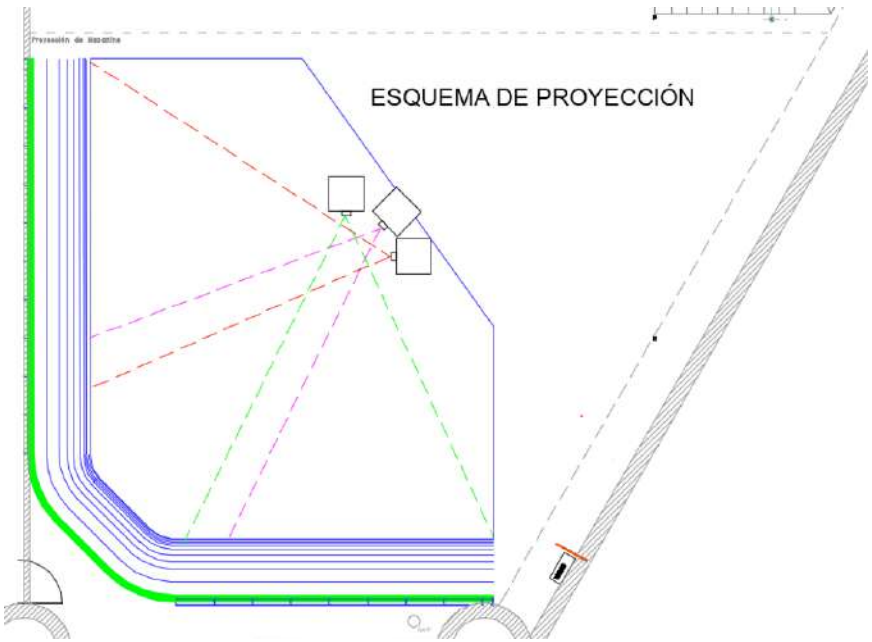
| ESQUEMA DE PROYECCIÓN CONTEMPLADO
